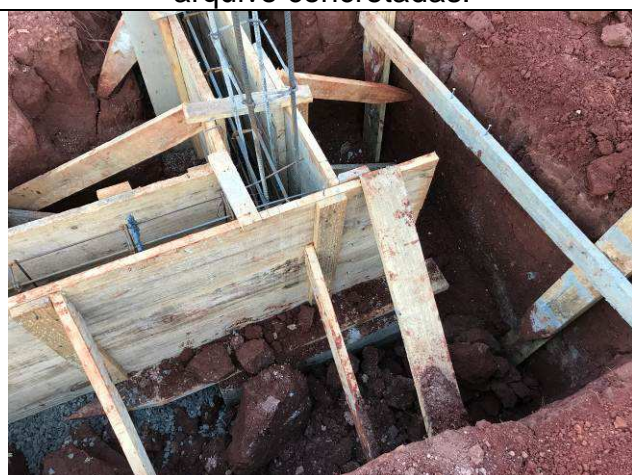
C: Bloco e formas/armaduras das vigas baldrames da guarita.
